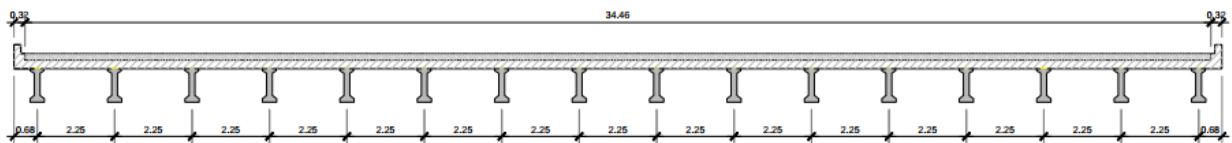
Sezione trasversale dell'impalcato – Stato di fatto
